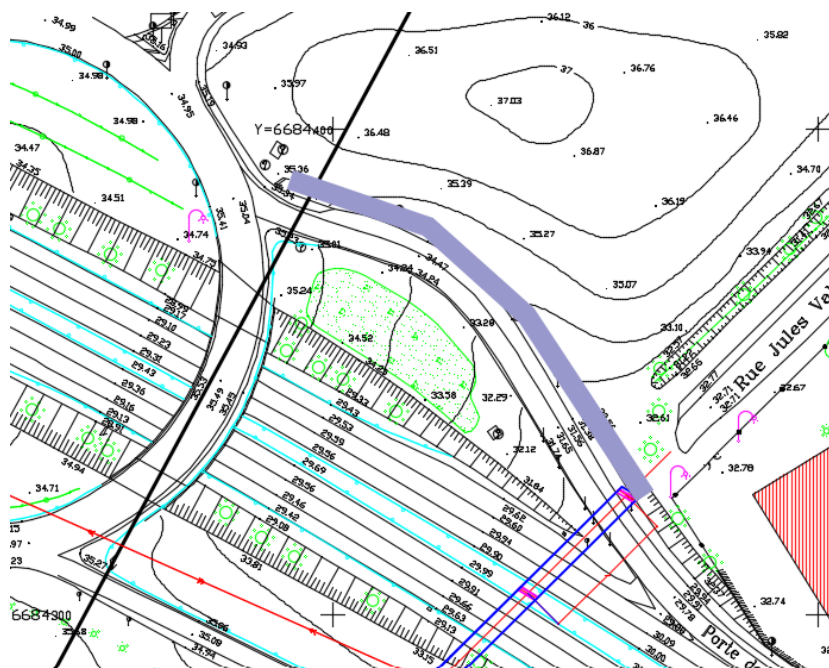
Variante d'implantation de la rampe nord d'accès à la passerelle
